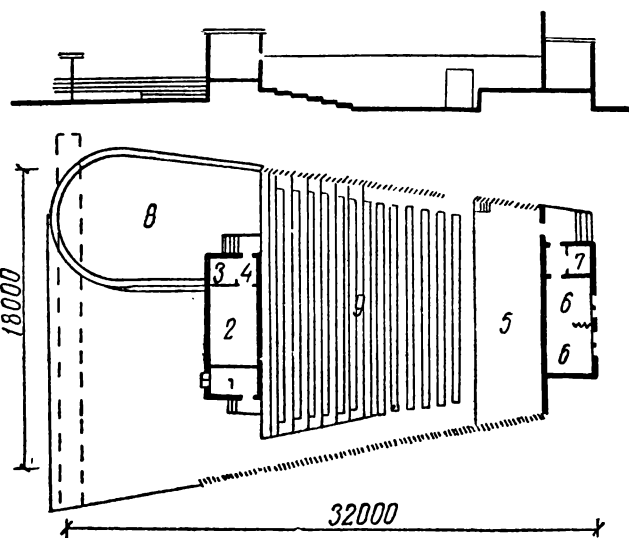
План проекта киноконцертной площадки на 300 мест (план):
